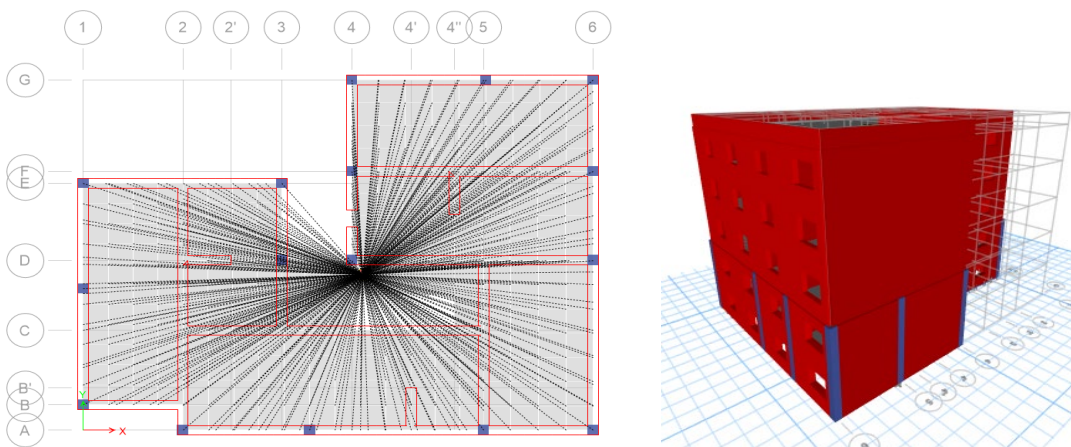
Pozicioni i kolonave në plan dhe në 3D
